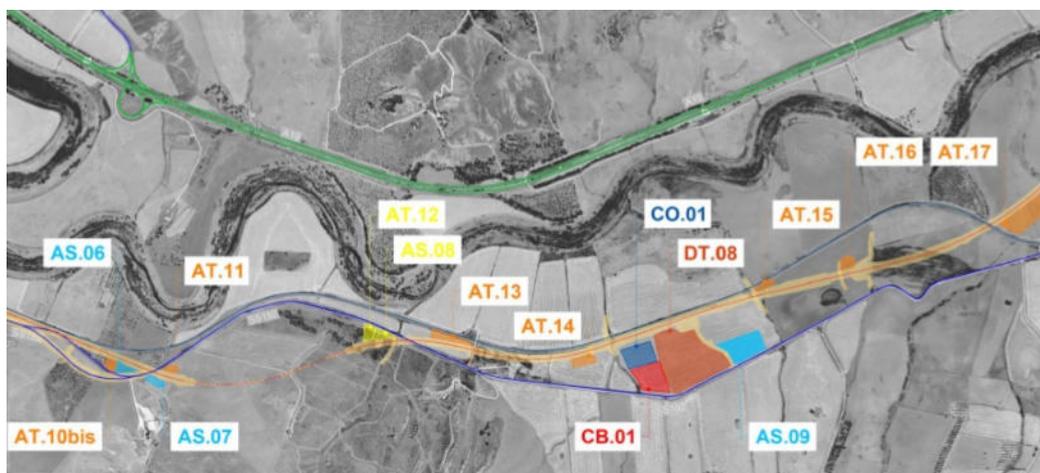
Localizzazione del CB.01 nell’ambito delle opere e dei cantieri previsti nel Progetto
